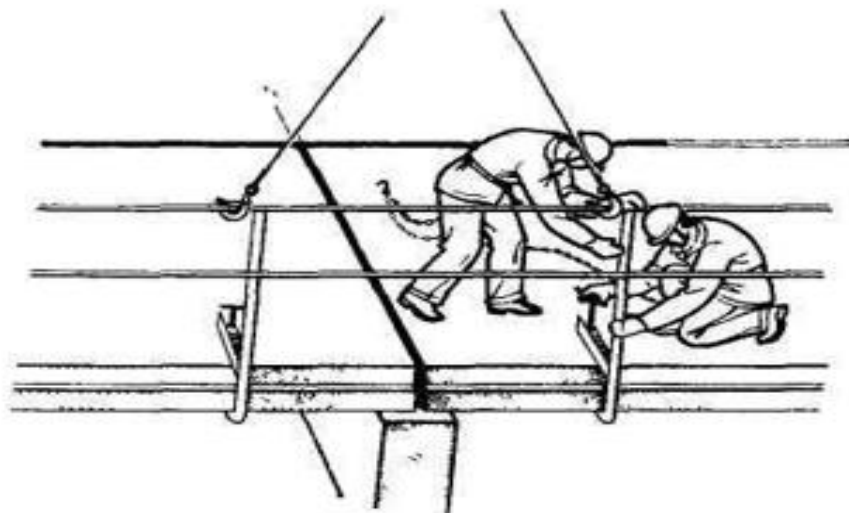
Укладка и анкеровка плиты перекрытия.
